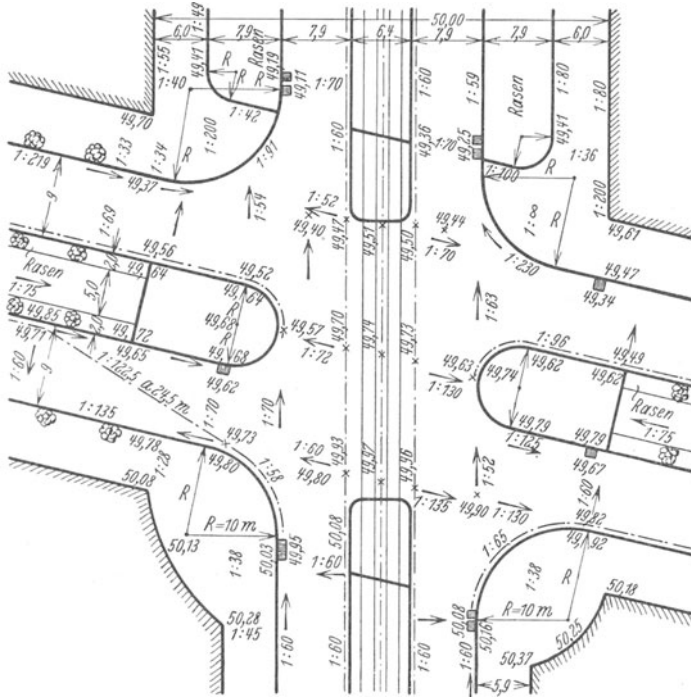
Kreuzung zweier Stadtstraßen. Entwurf für die Ausführung.
